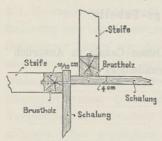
Ecke der Verschalung eines Stampfbetonbauwerks.
